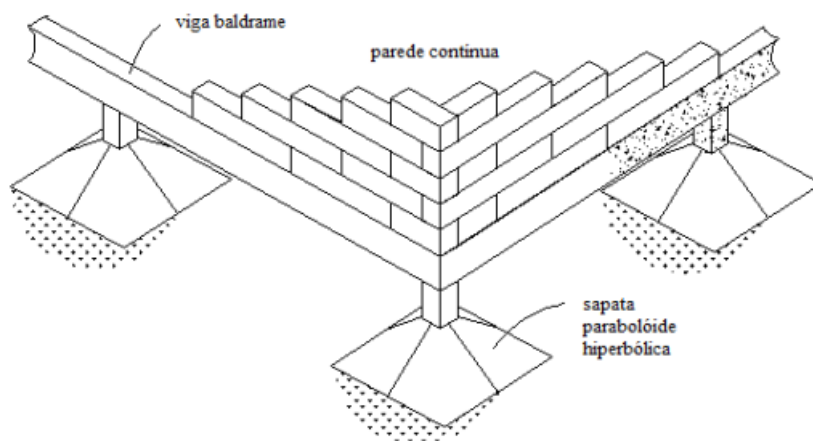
Sapatas isoladas côncavas ligadas por vigas contínuas (Figueiredo, 2010)
